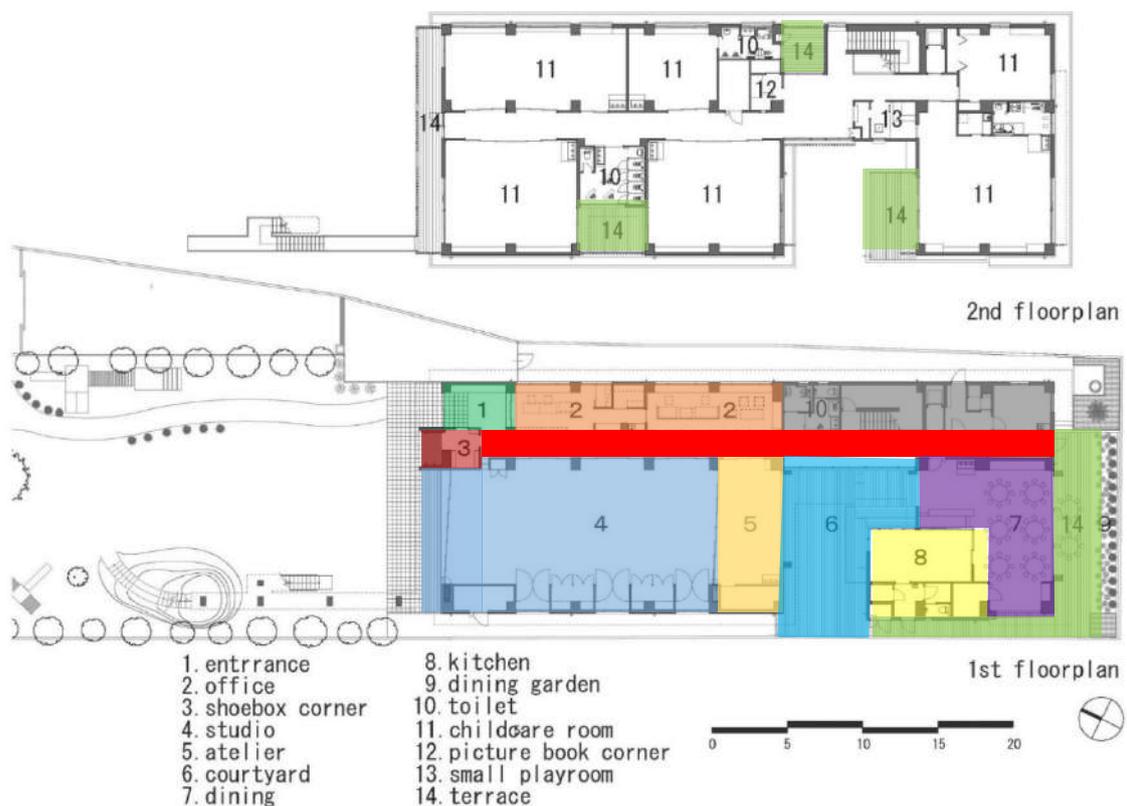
Plano de Zonificación del proyecto Kindergarten y Guardería Hanazono. Fuente: Página Web Archdaily.
